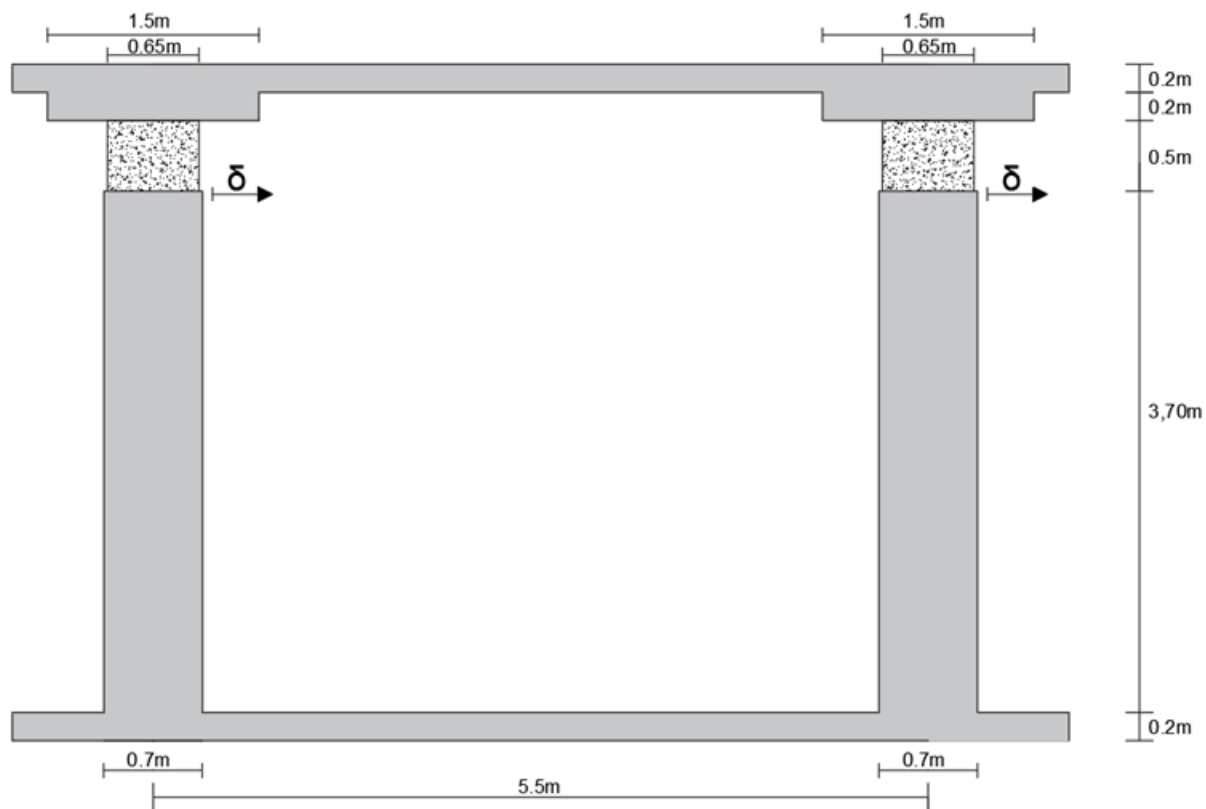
Esboço do sistema de isolamento antes de definir modelo de apoio e grelha de vigas de travamento
